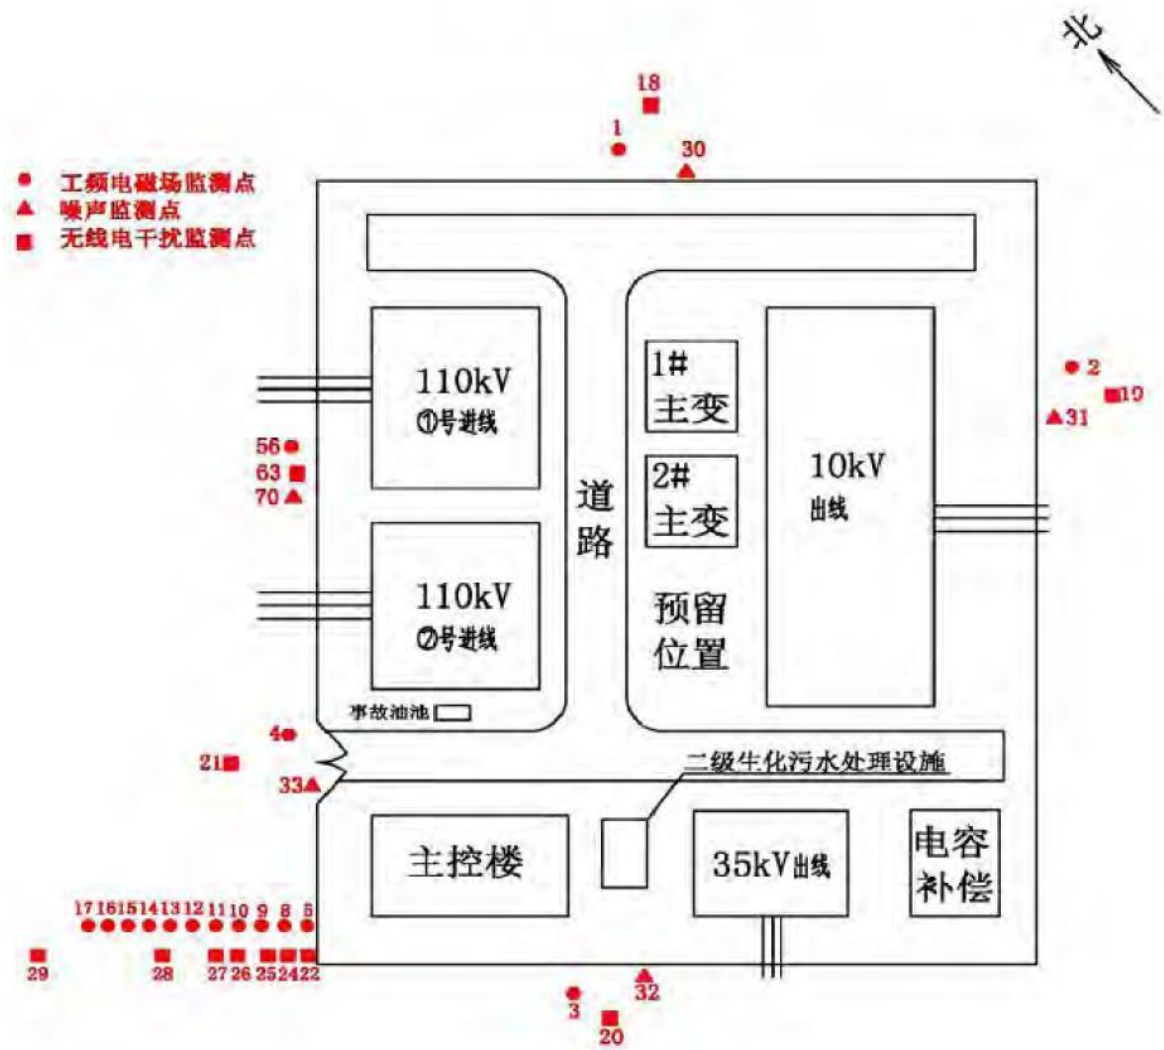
类比 110kV 金所变电站站区总平面布置及监测点布置图
